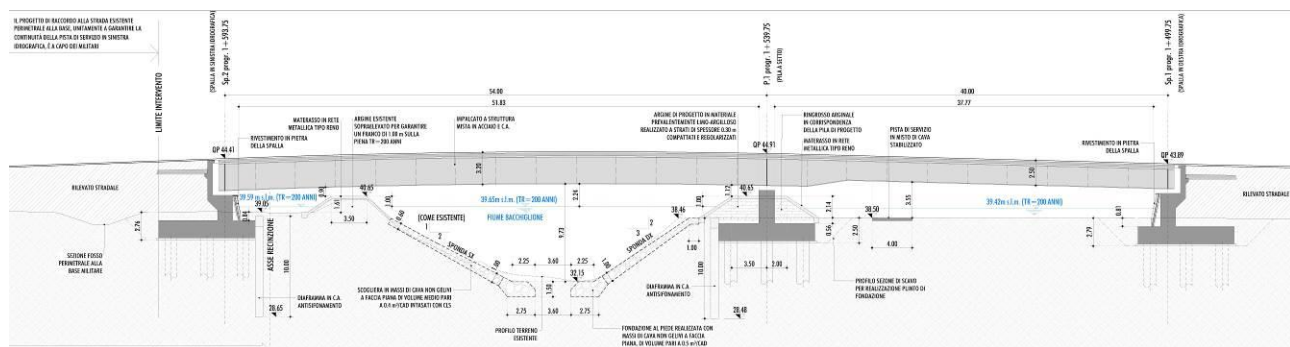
SEZIONE LONGITUDINALE PONTE SUL FIUME BACCHIGLIONE
